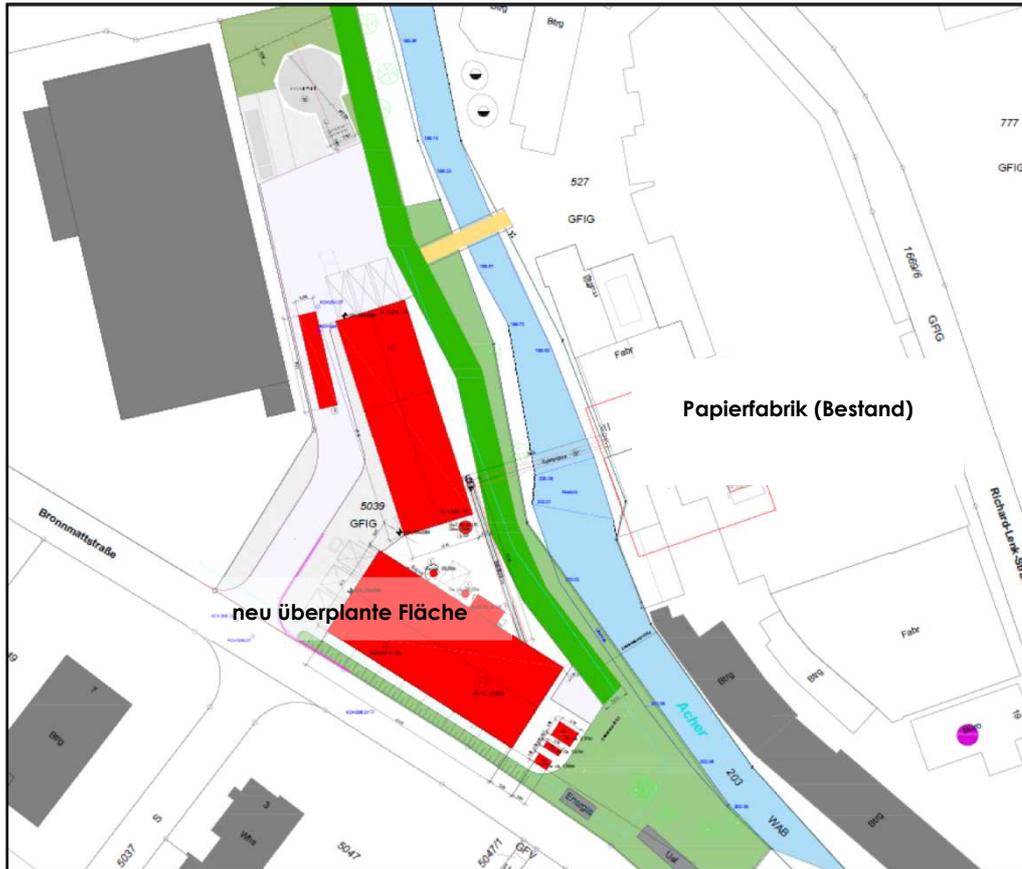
Übersichtslageplan [Quelle: Vermessungsbüro Gerber/GETEC]
